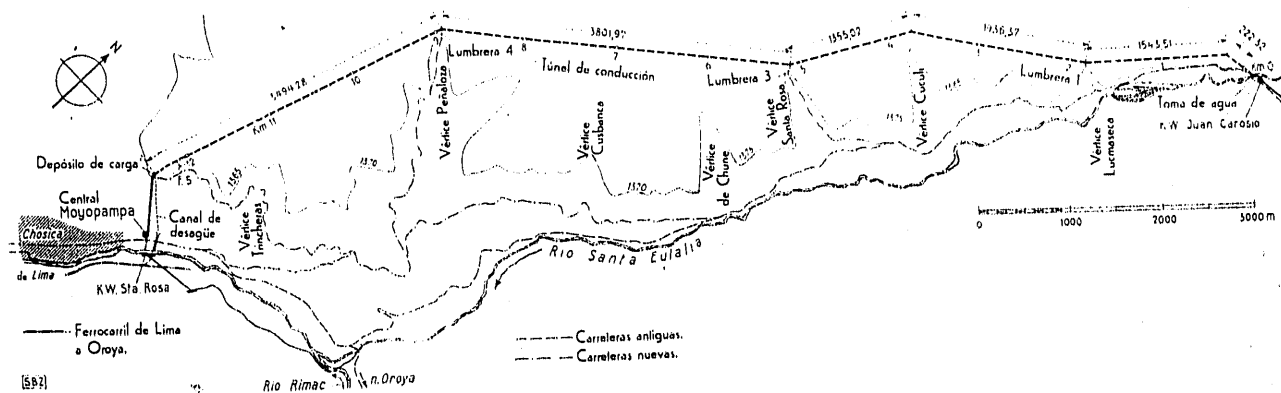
ª — Plano general del salto de Moyopampa. Escala: 1:75 000.
